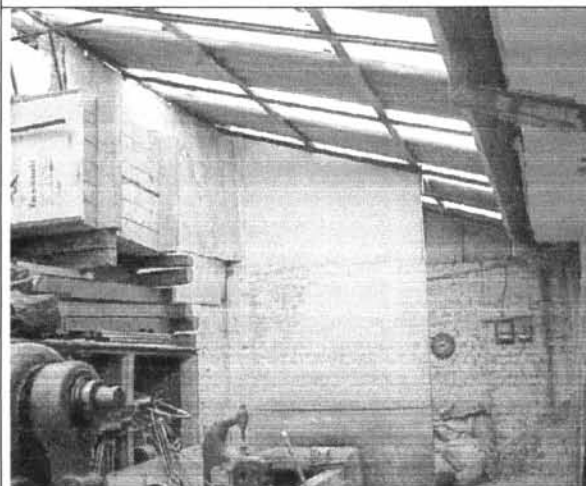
Entramado en madera apoyada sobre muros de carga en mampostería.
